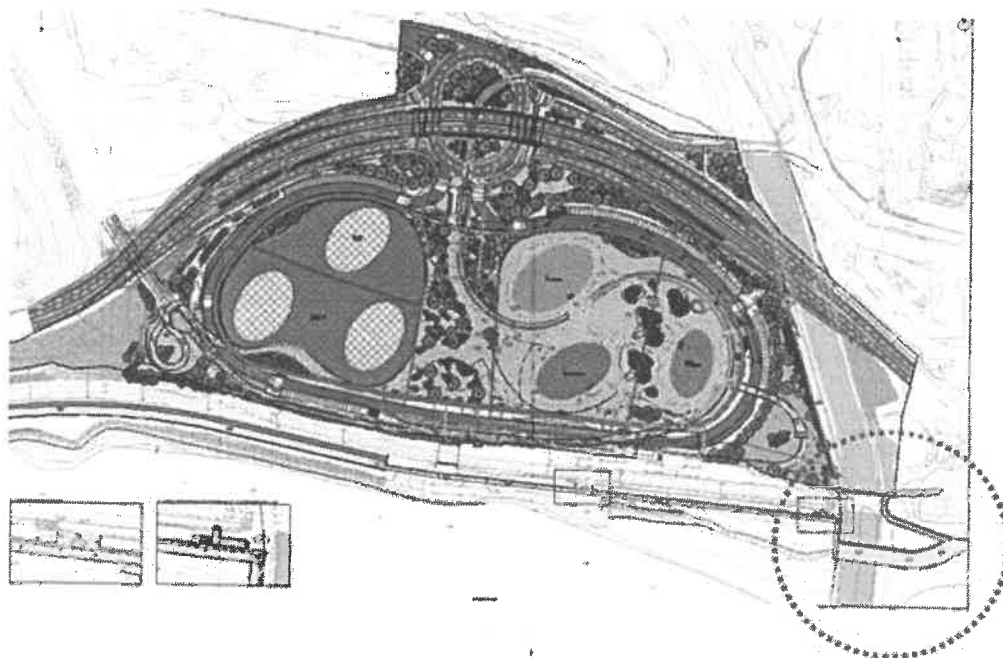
Extrato da “Planta de Fase Intermédia UE1 – UE3” (Des. A-28A) (a vermelho, assinala-se a área na qual fica assegurado o acesso ao passeio marítimo e à praia da C. Quebrada)
